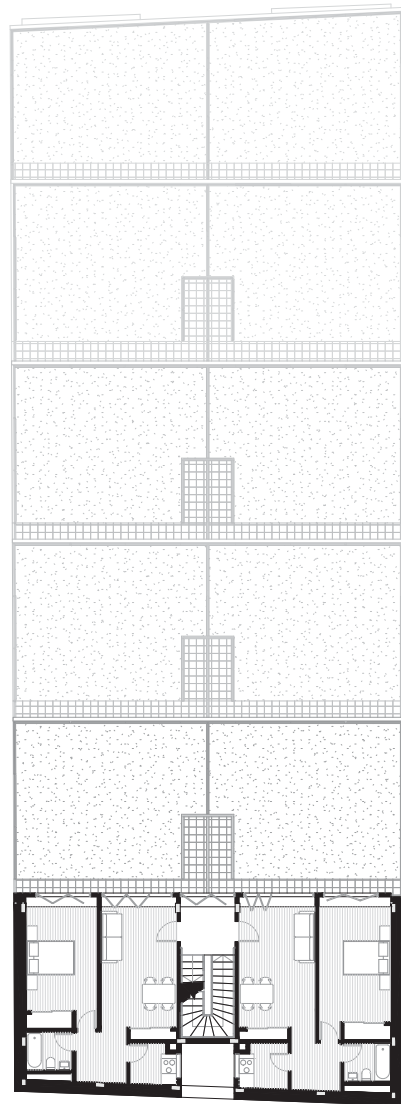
Primera planta del cuerpo elevado cota 8,70m
